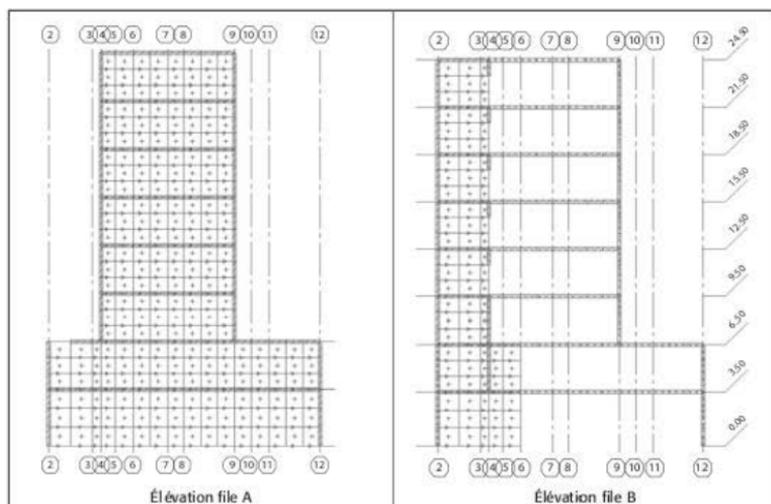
Élévation des voiles – plan XZ (1/4)
